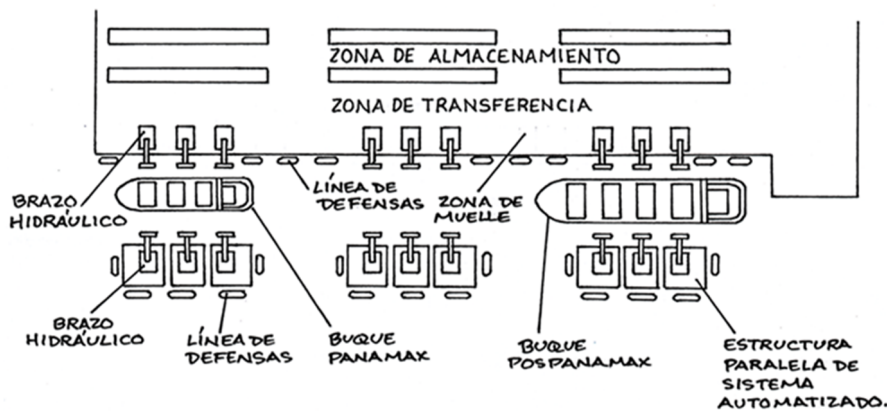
Vista de planta del muelle proyecto basado en maniobra de atraque esperada.
